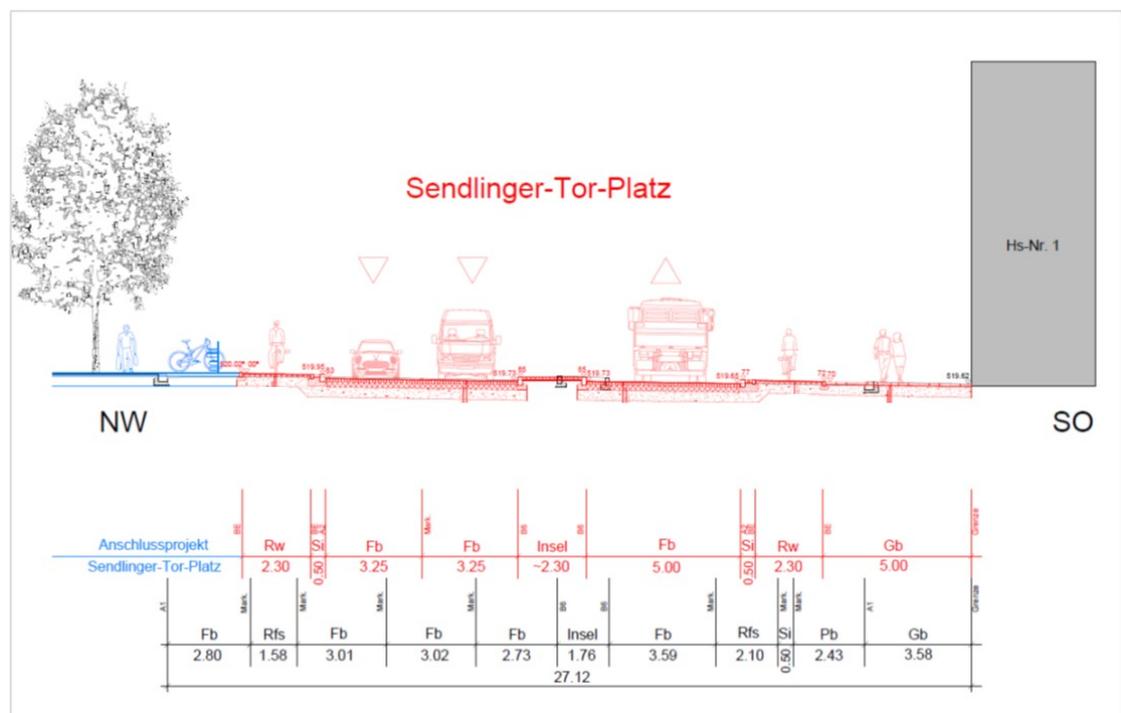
Querschnitt Sendlinger-Tor-Platz Höhe Kreissparkasse Variante 1 (vgl. auch Lageplan Anlage 1), Quelle: Landeshauptstadt München
